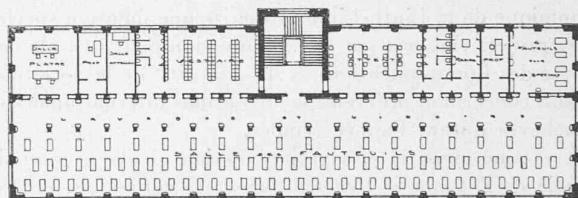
Plan du 1^{er} étage. — 1 : 800.
